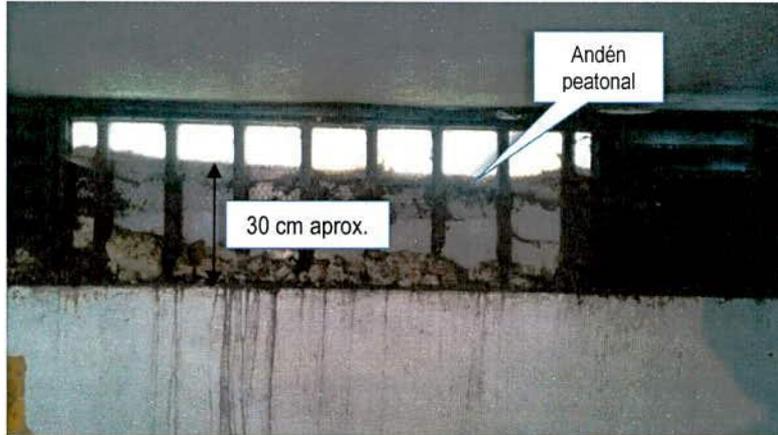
Deformación del suelo de cimentación en el costado suroriental de la edificación Carrera 16 # 80 – 07 (Predio 1, Figura 1).
